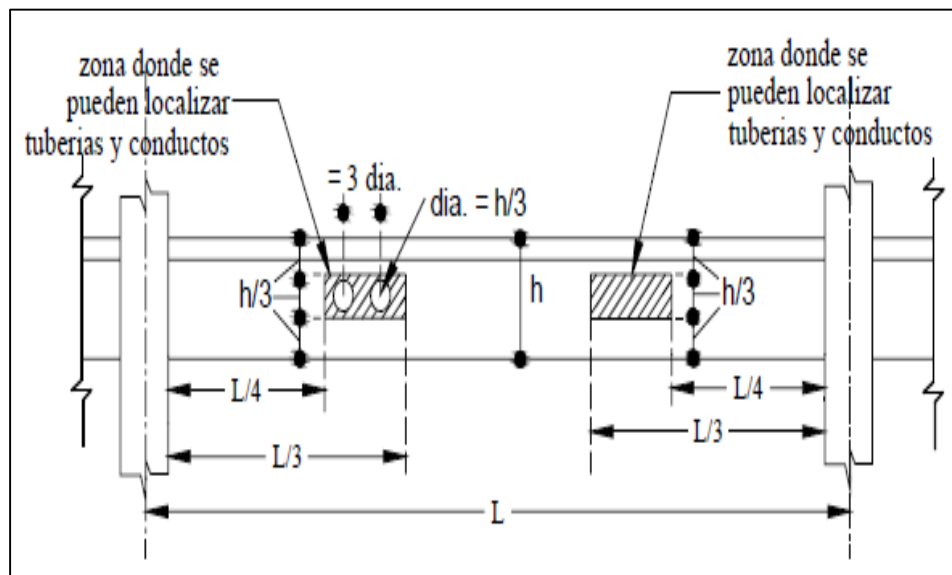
Localización de Conductos y Tuberías que Atraviesan Horizontalmente Vigas, Vigas Maestras y Viguetas.
